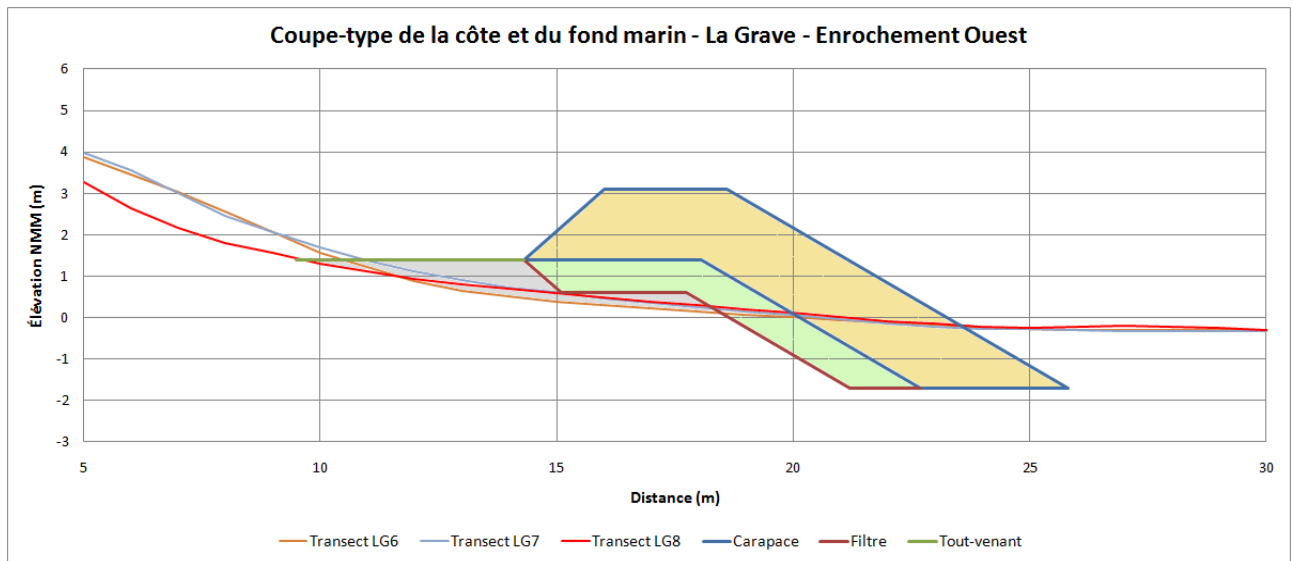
Coupe type d'une protection en enrochement de la partie ouest de La Grave
